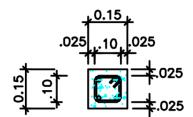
Detalle de Viga Intermedia con sus dimensiones
